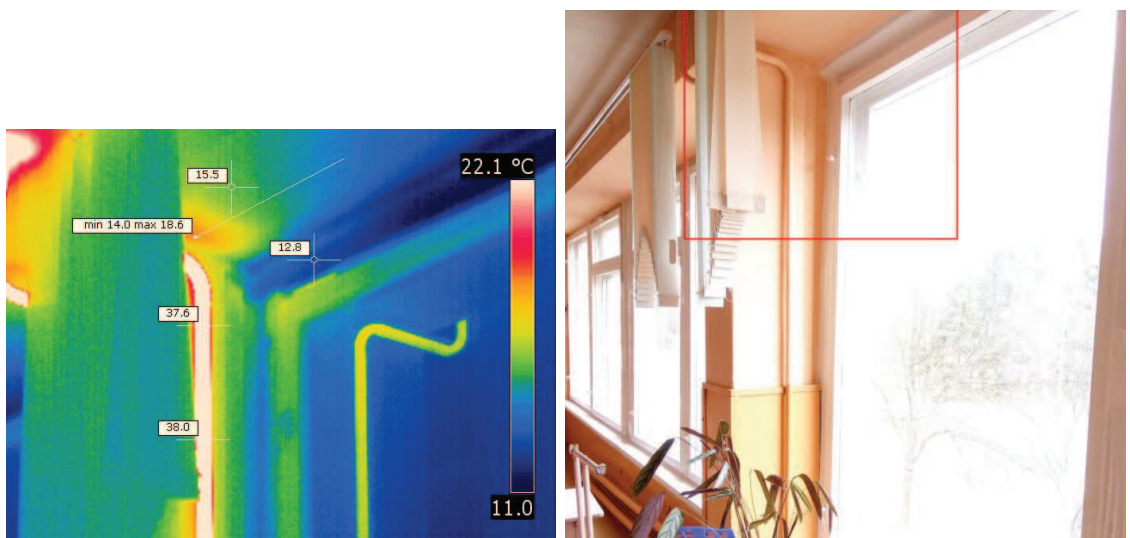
Стена помещения №214 (учебный класс), северный фасад
